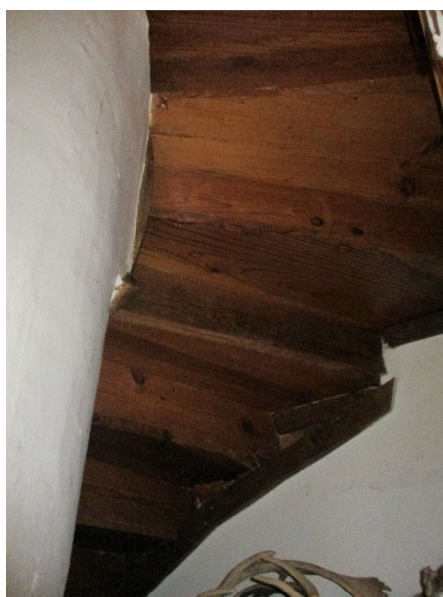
Fotografia do apoio das bases da escada nas paredes que fecham a caixa de escadas através de barrotes pregados diretamente na parede.
